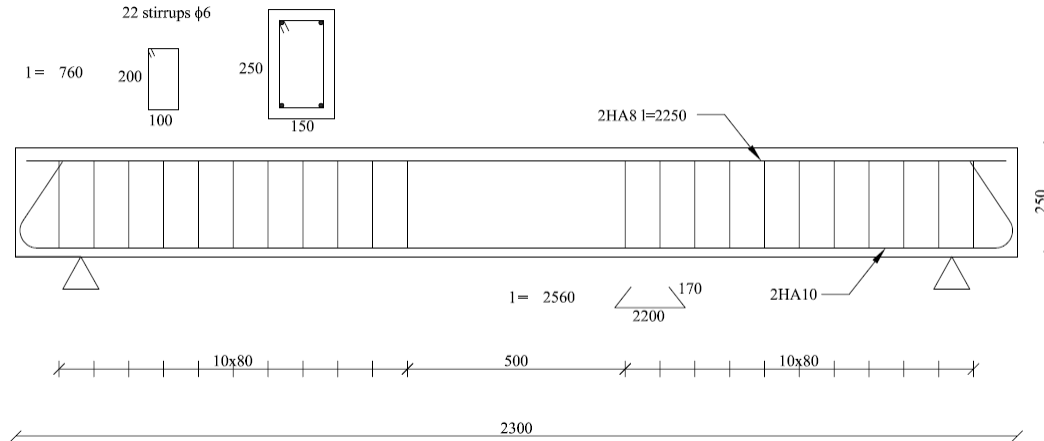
Plan de ferrailage des poutres en béton armé (cotations en mm)
